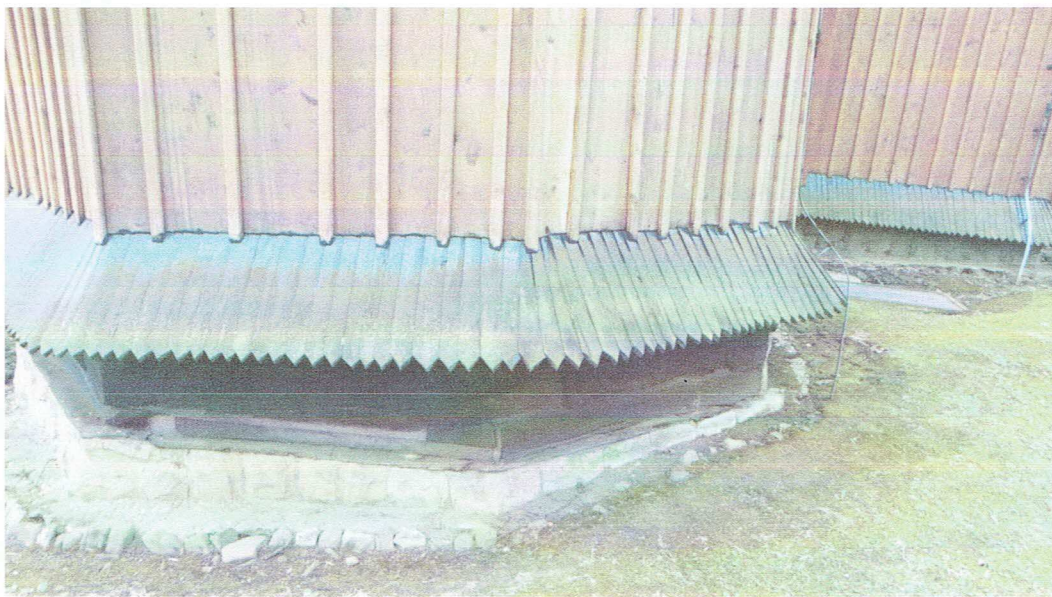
Korozja pokrycia dachu wywołana przez mchy i porosty. Fot. autor.
